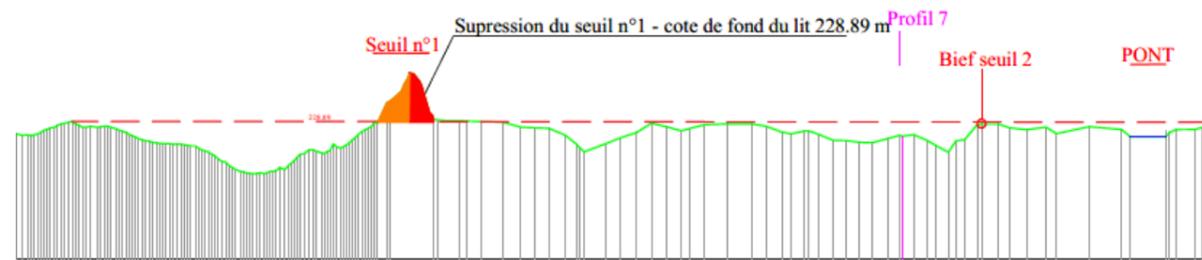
Extrait profil en long du Madon au droit du seuil 1
